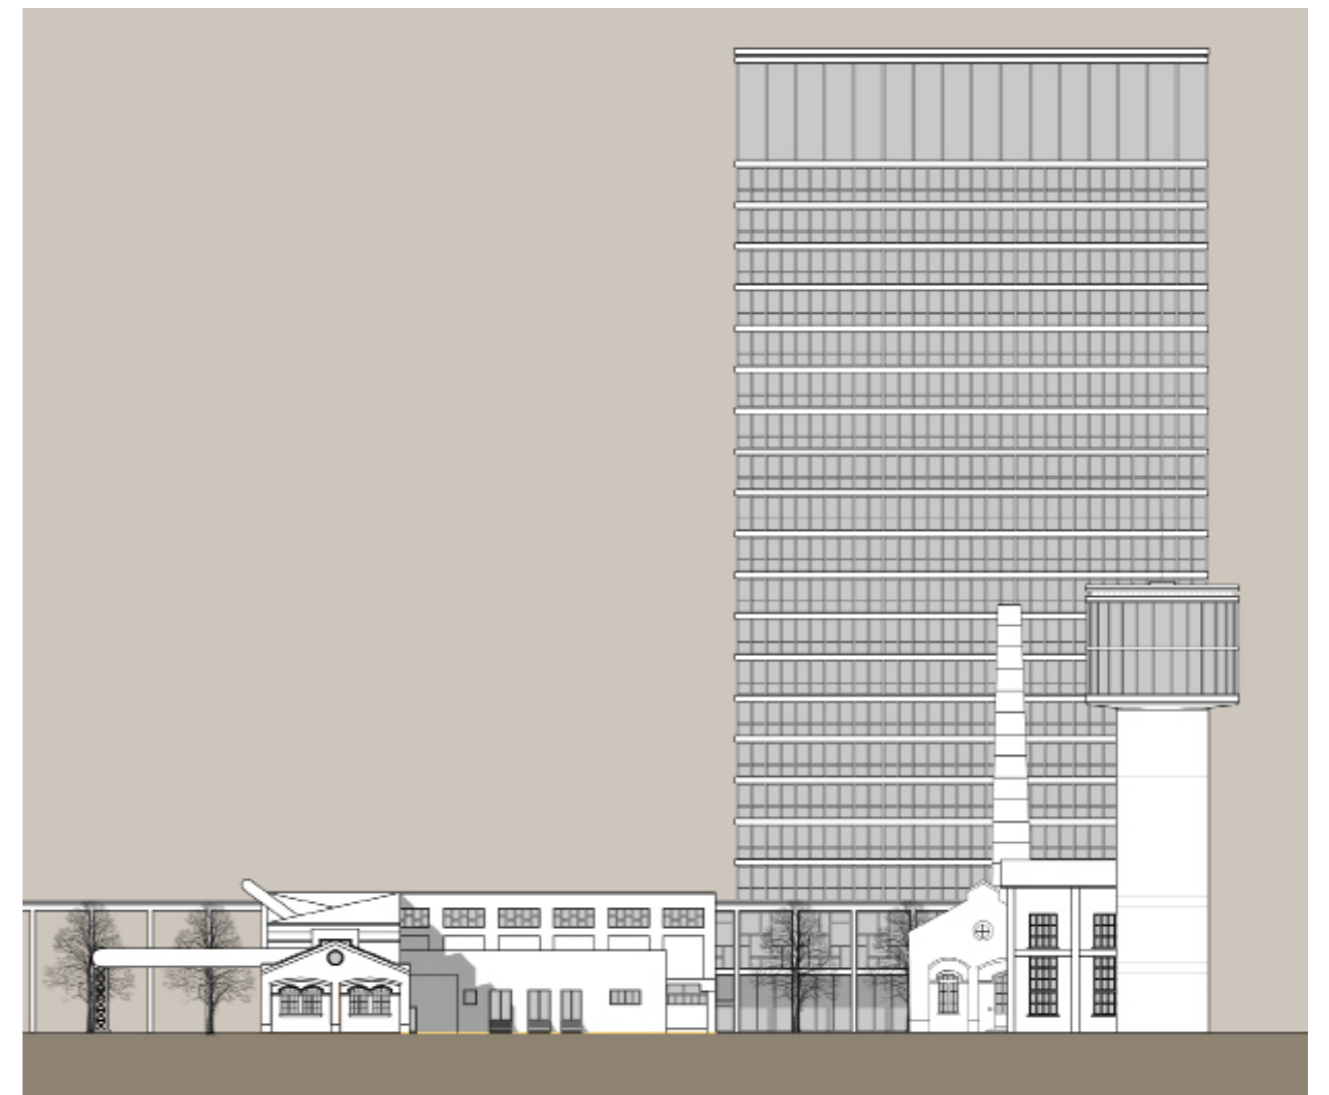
prospetto delle preesistenze nel sistema di piazze del progetto
